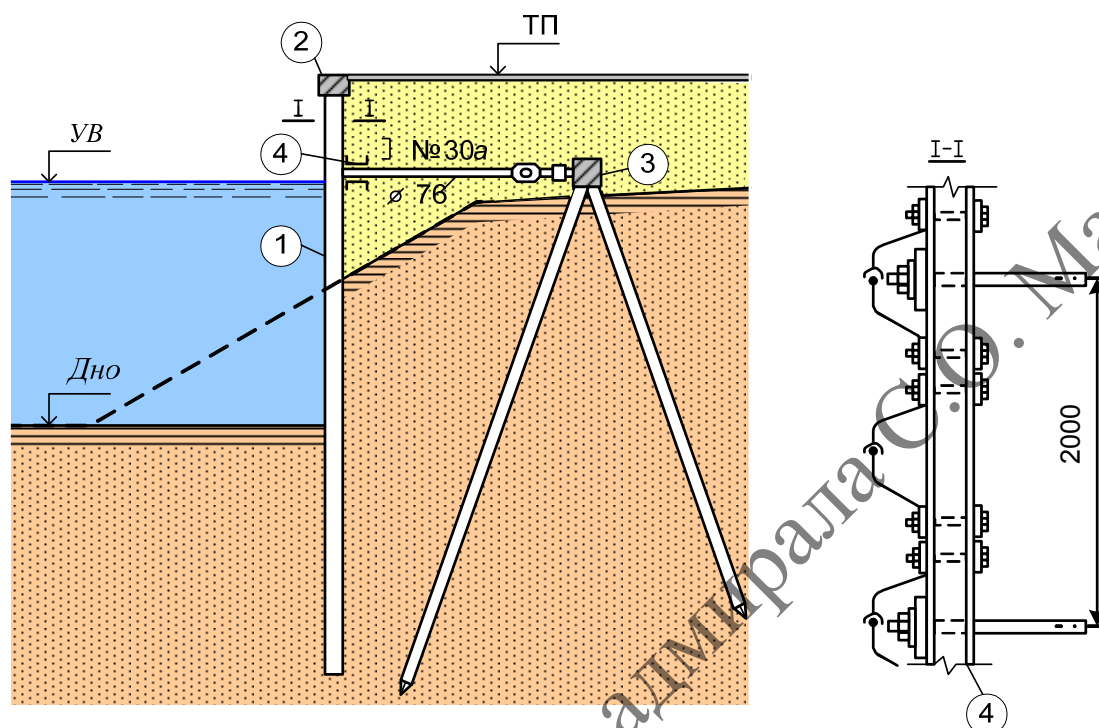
Стальная одноанкерная стенка с козловыми опорами из железобетонных свай
